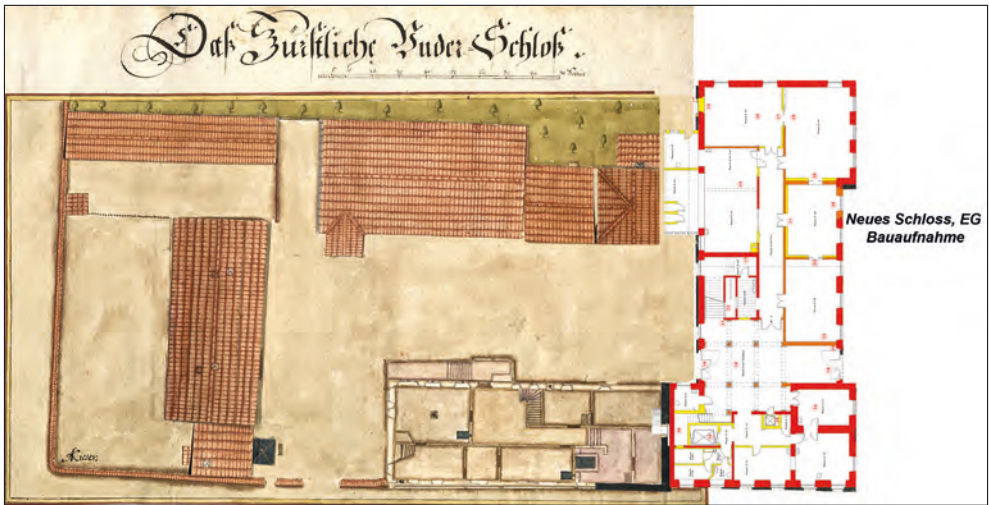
Die Anlage des Unteren Schlosses mit dem Neubau Rettis zur Zeit der Gräfin von Würben. Grundlage der Darstellung ist der aufklappbare Plan Kiesers von 1685 (links), ergänzt um den Grundriss der Bauten Rettis.
